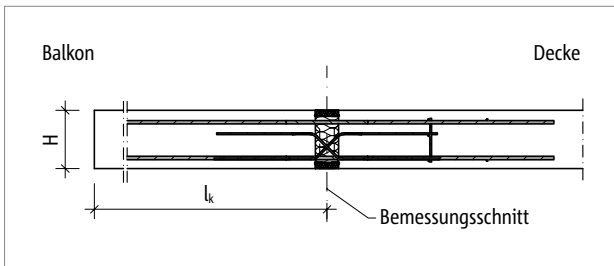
Schöck Isokorb® T Typ DP: Statisches System
